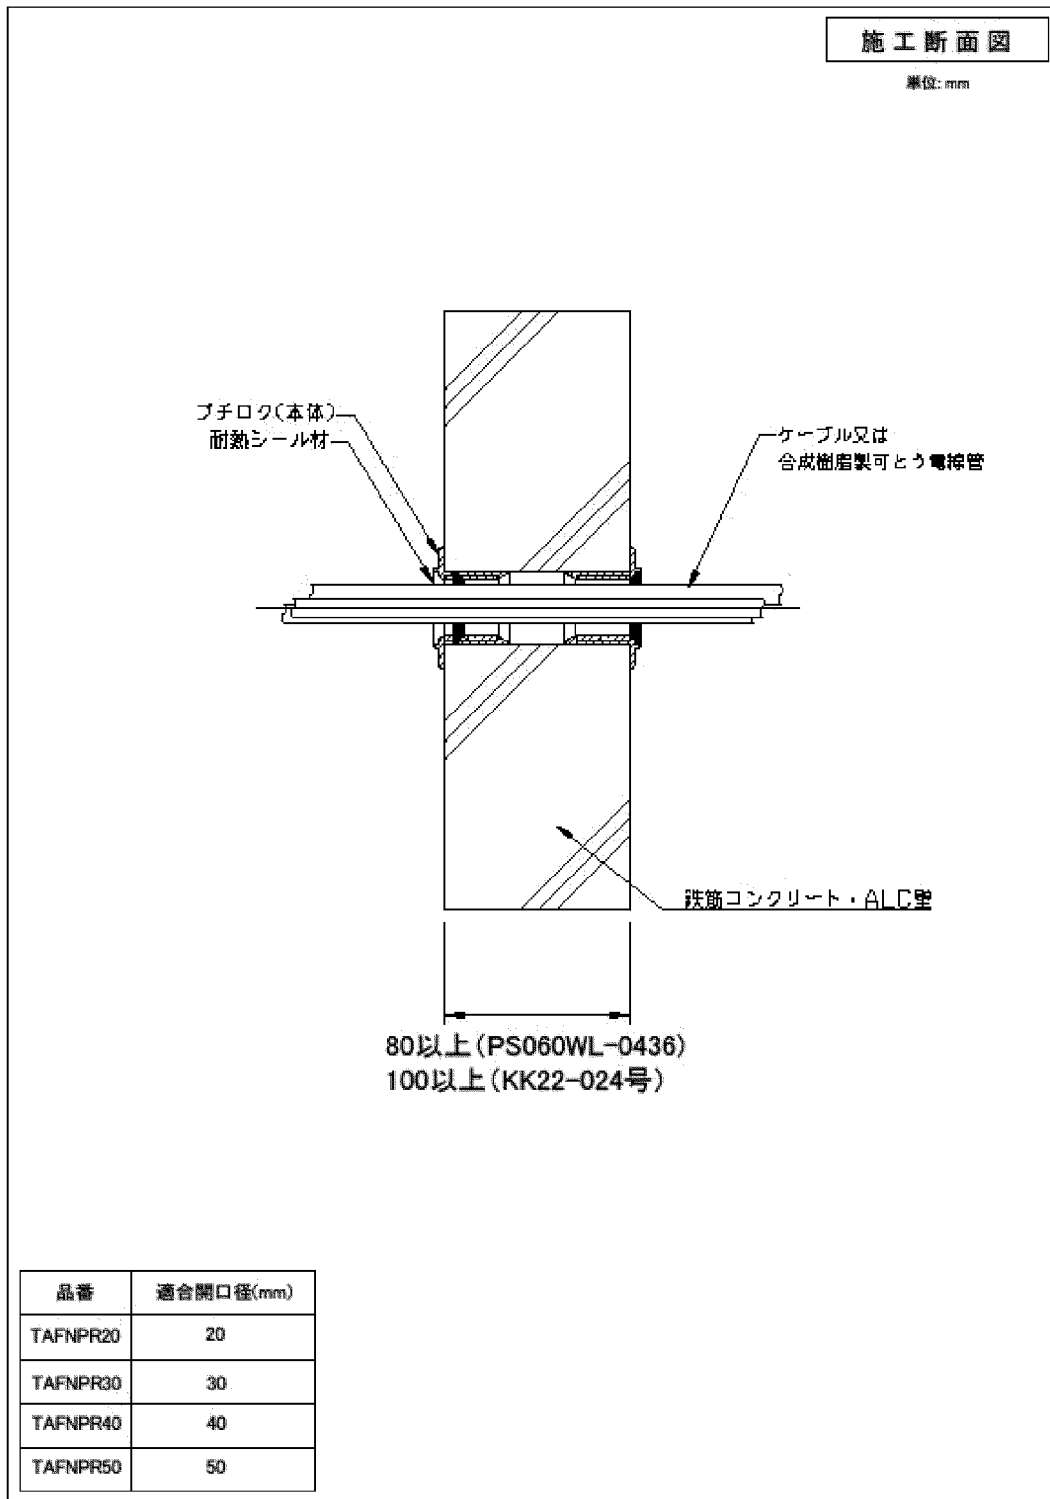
鉄筋コンクリート(RC)・ALC 壁(PS060WL-0436, KK22-024号)標準施工図
